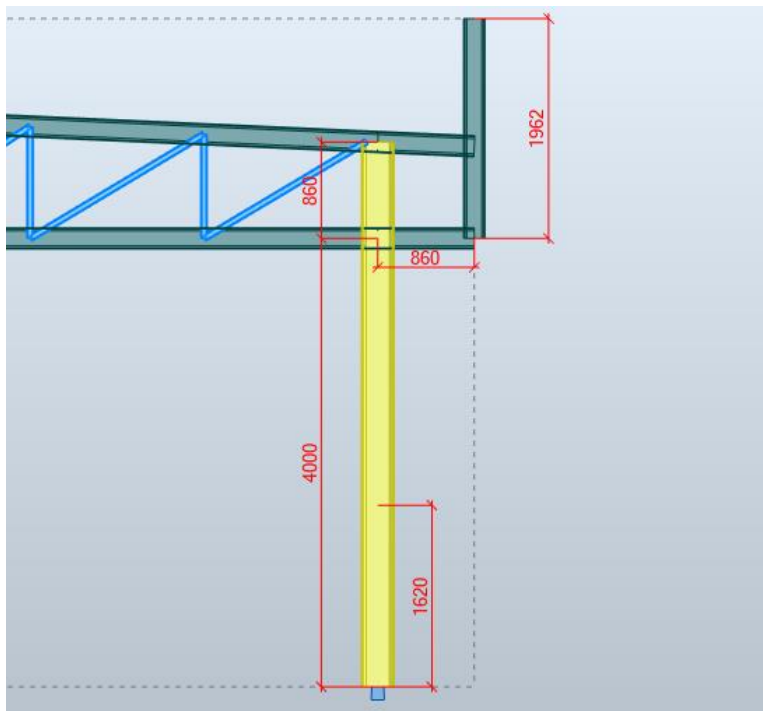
Medidas (mm) do pilar do pórtico tipo. (Imagem capturada do ROBOT).
